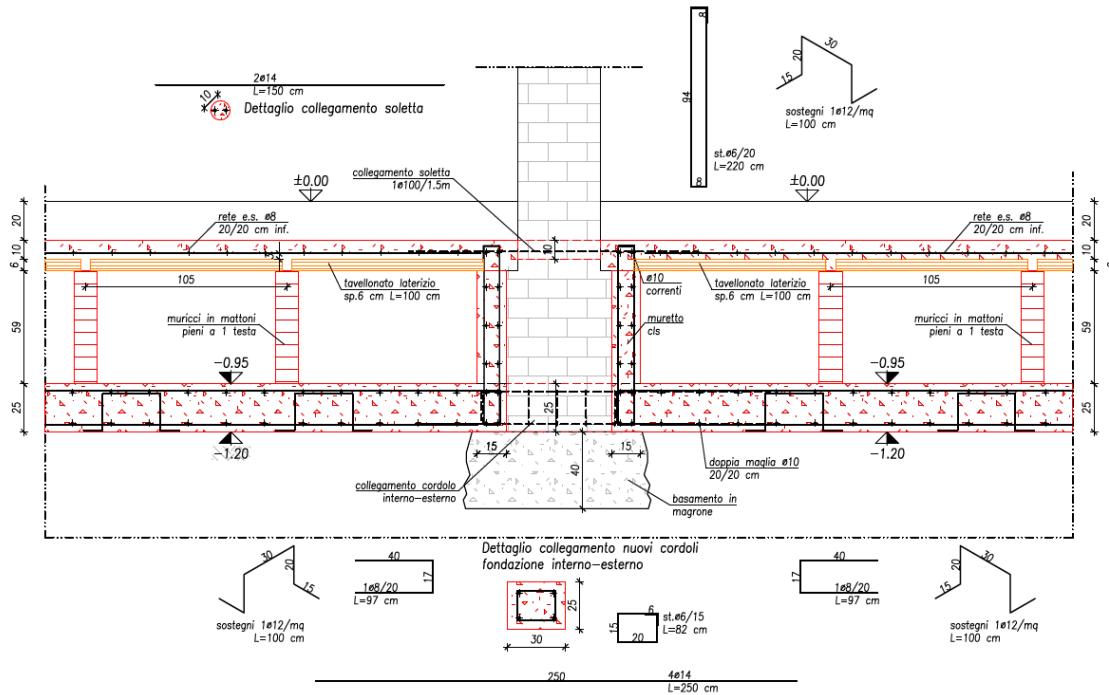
Stralcio dell'intervento di fondazione con platea in c.a. e muricci in laterizio
